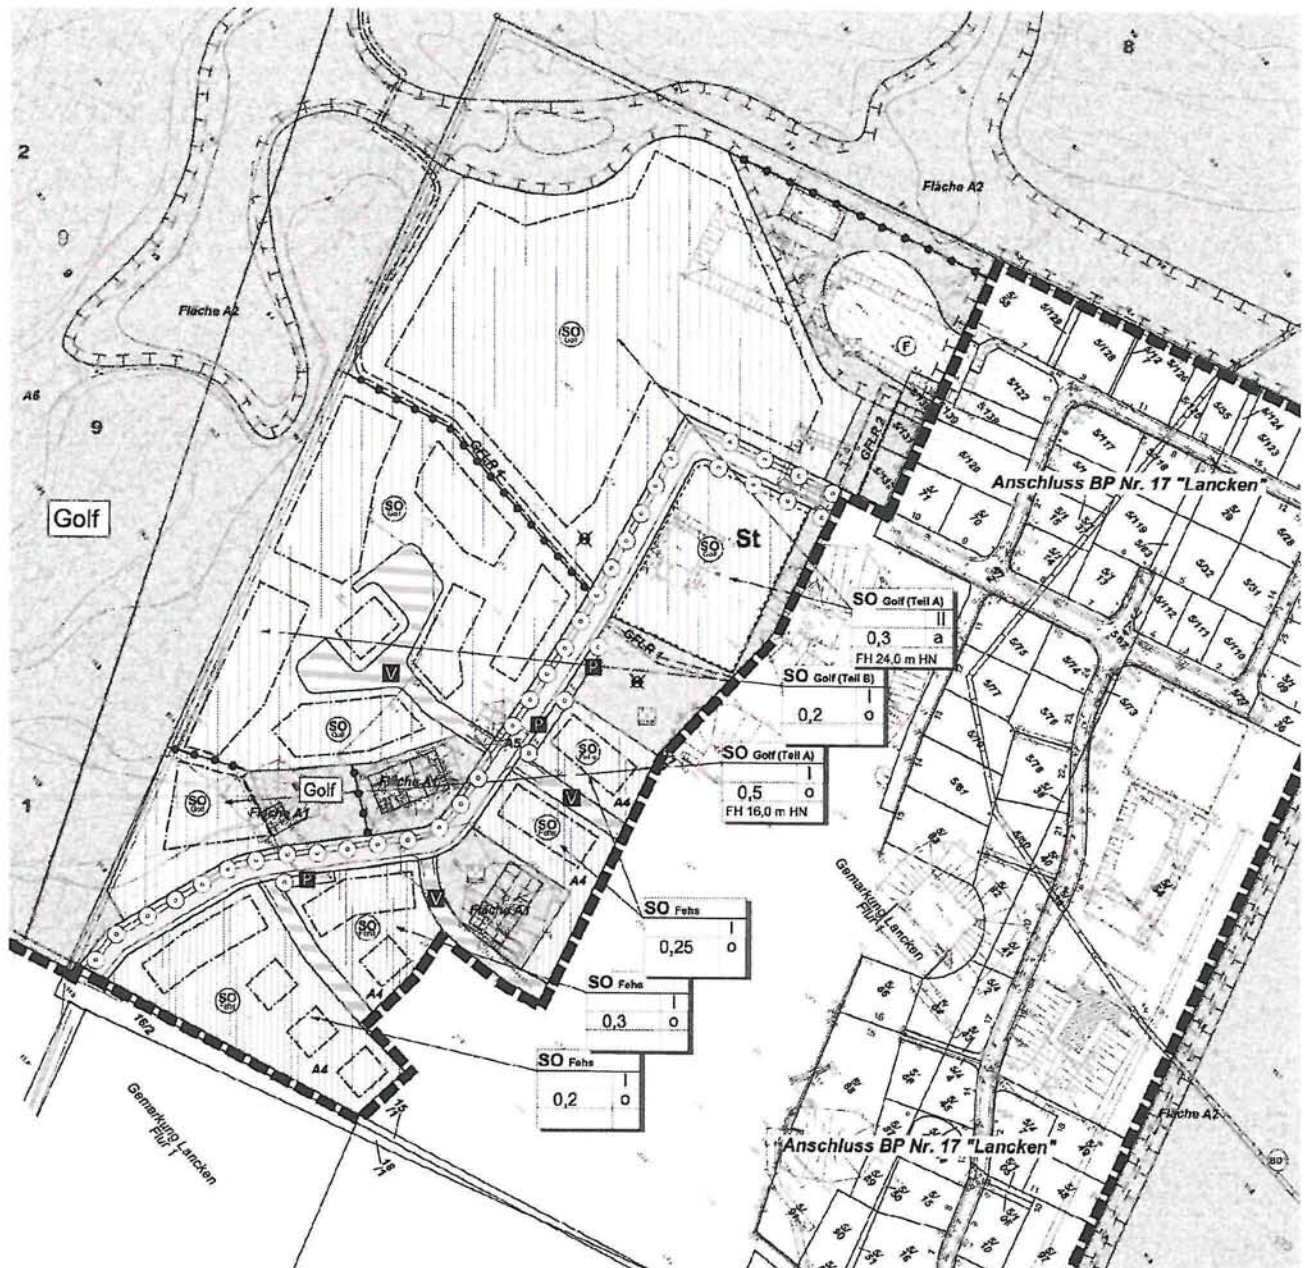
Ausschnitt Planzeichnung (Teil A) des Ursprungsplans
